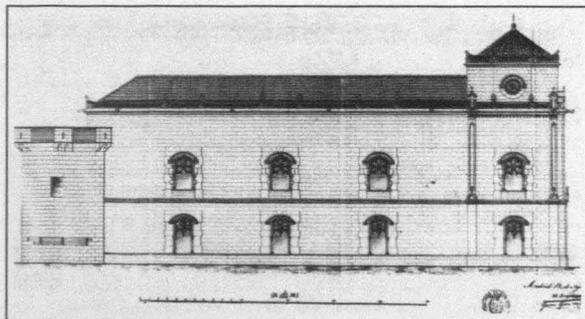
Alzado de la fachada del Ala Este que da a la plaza de las Bernardas, según el proyecto de restauración de J. J. Urquijo. A.G.A., Sección de Educación y Ciencia.
